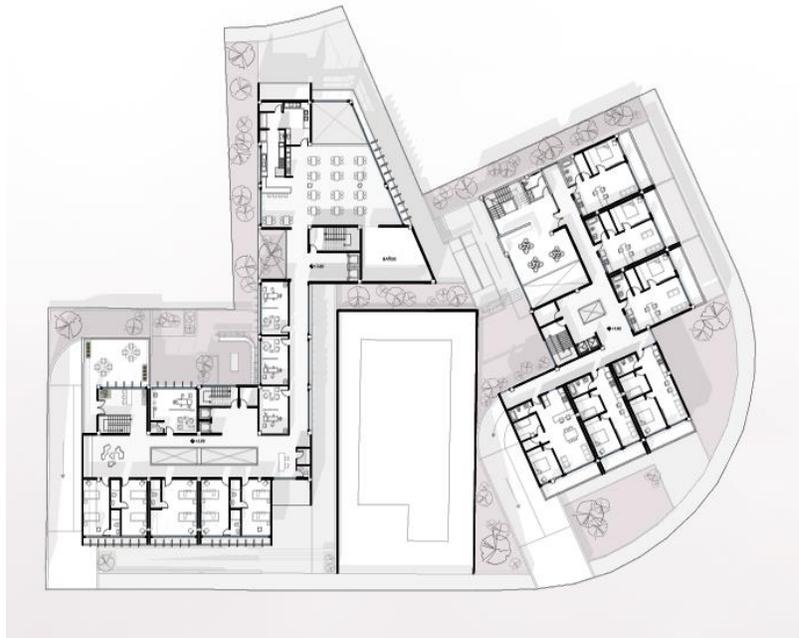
Planimetría: Planta Nivel I (N +3.60)
